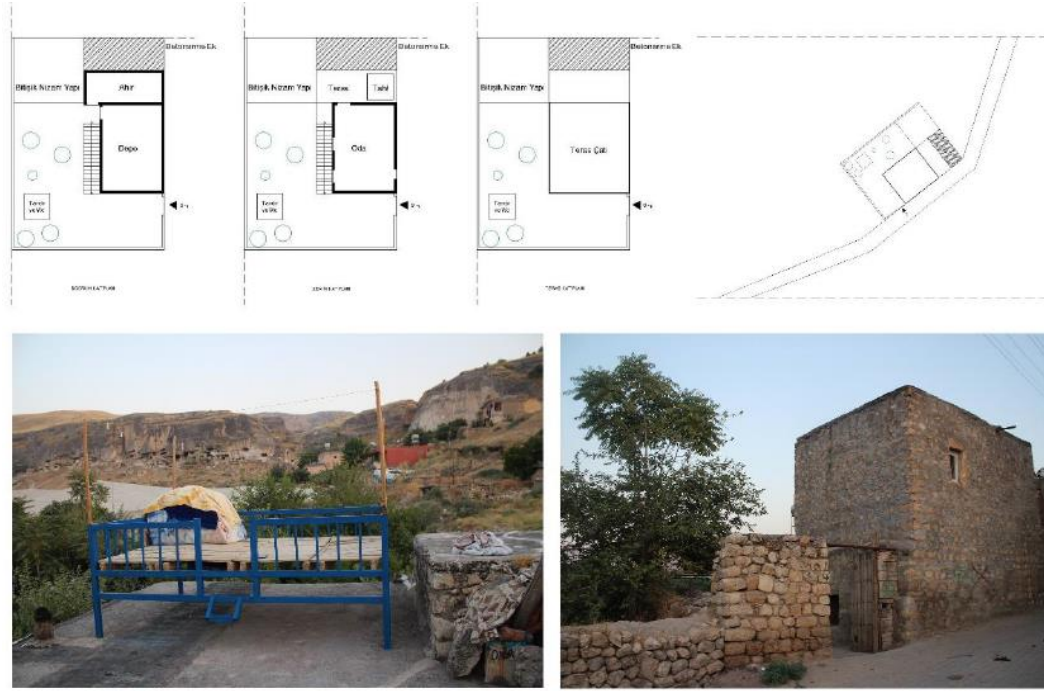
Avlu Tipleri ve Plan Şemaları (Numan and Owen, 2011)
